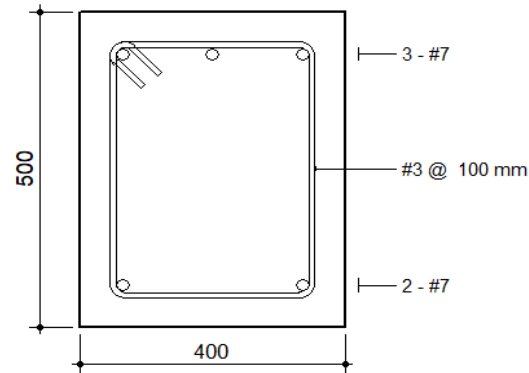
Sección de viga perimetral plantas 1, 2, 3 y 4. Fuente: Propia.
